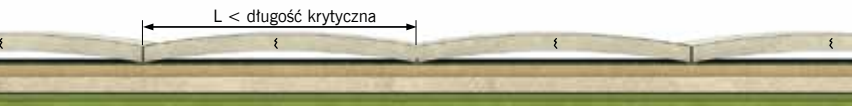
Schemat nawierzchni dyblowanej z betonu cementowego
